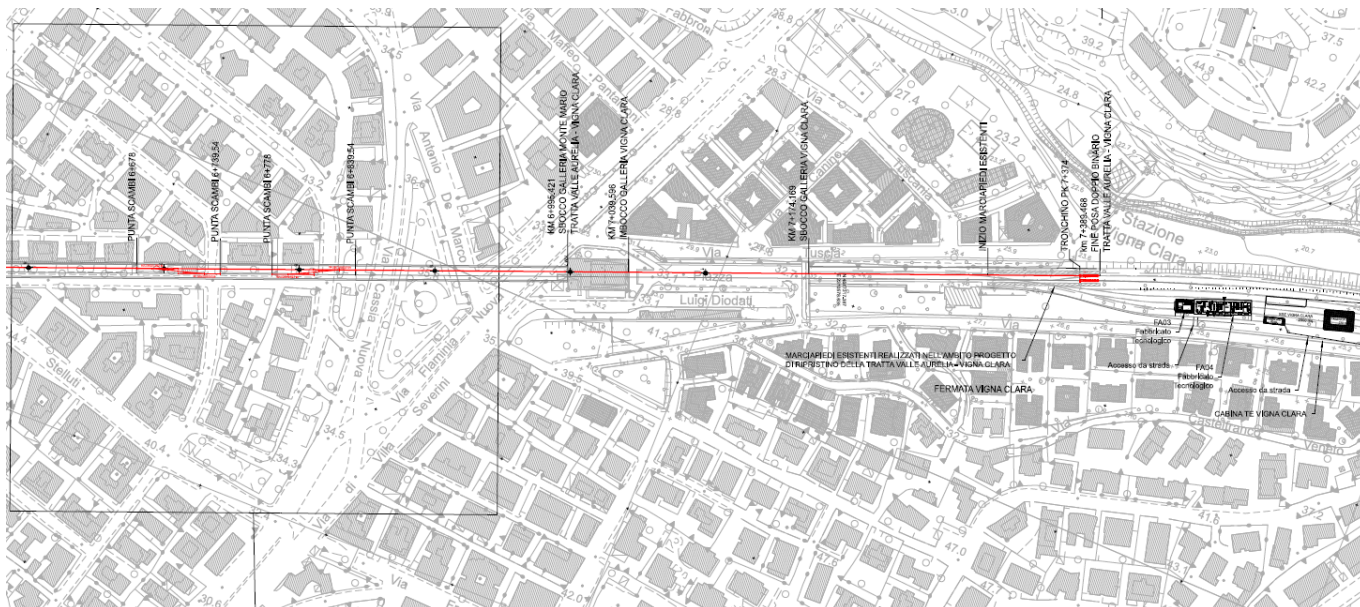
Stralcio planimetrico zona PES bivio Pineto
